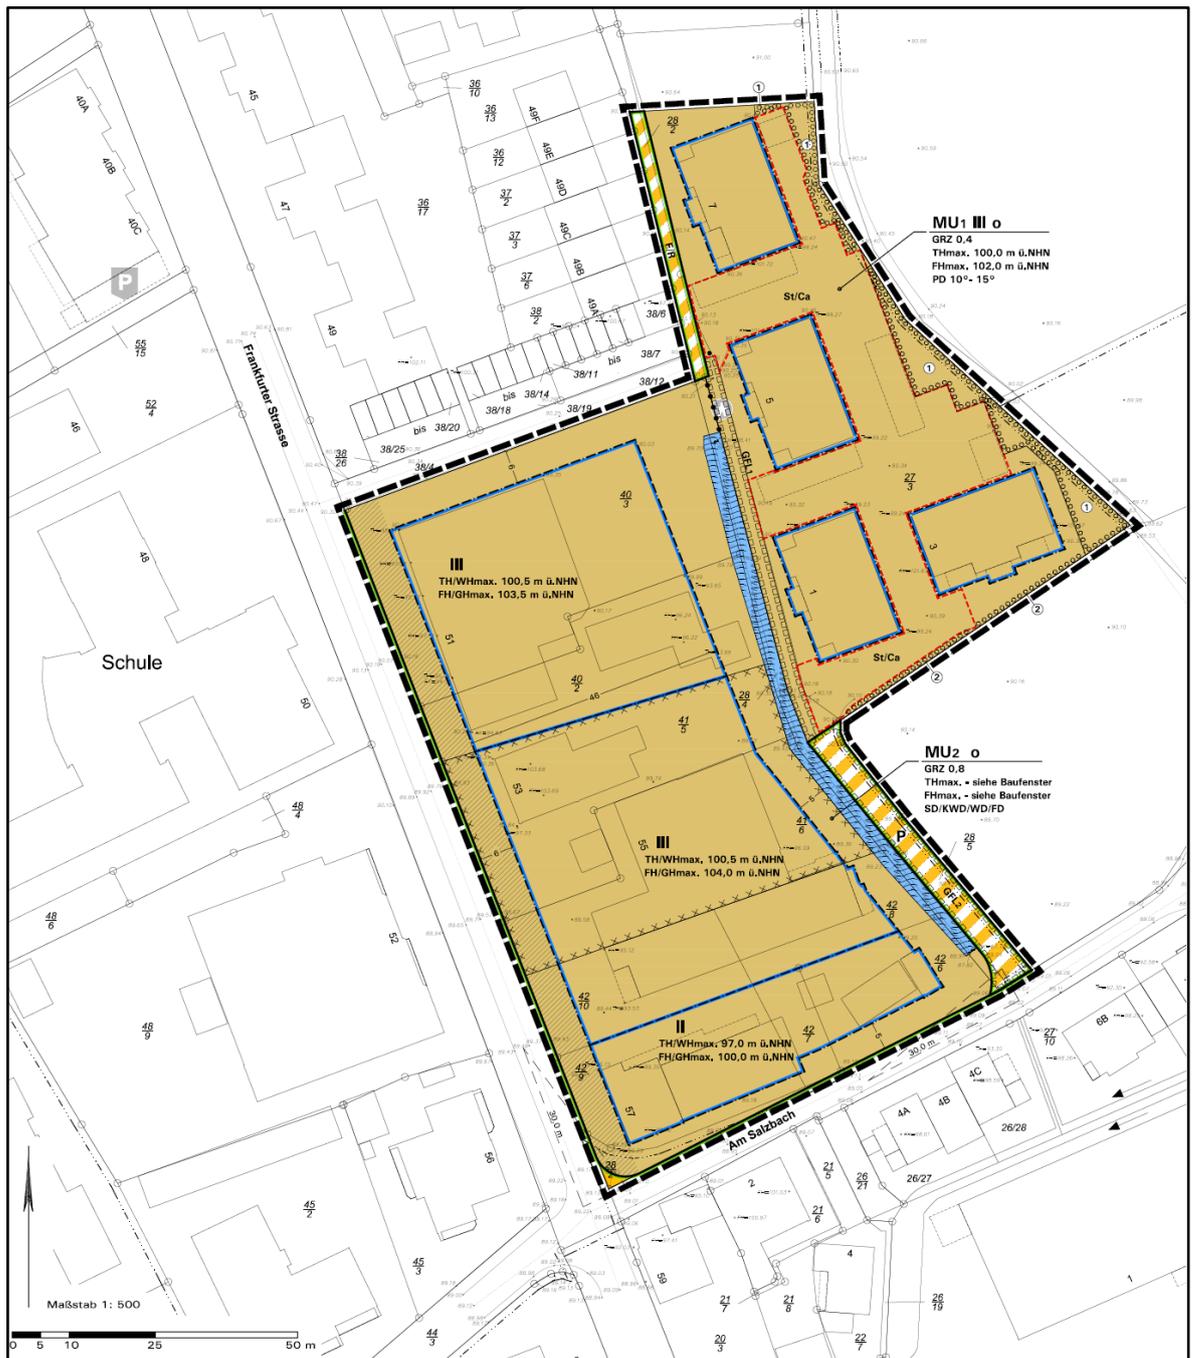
Ausschnitt aus dem Bebauungsplan Nr. 68 (Entwurf) [9], genordet, ohne Maßstab
